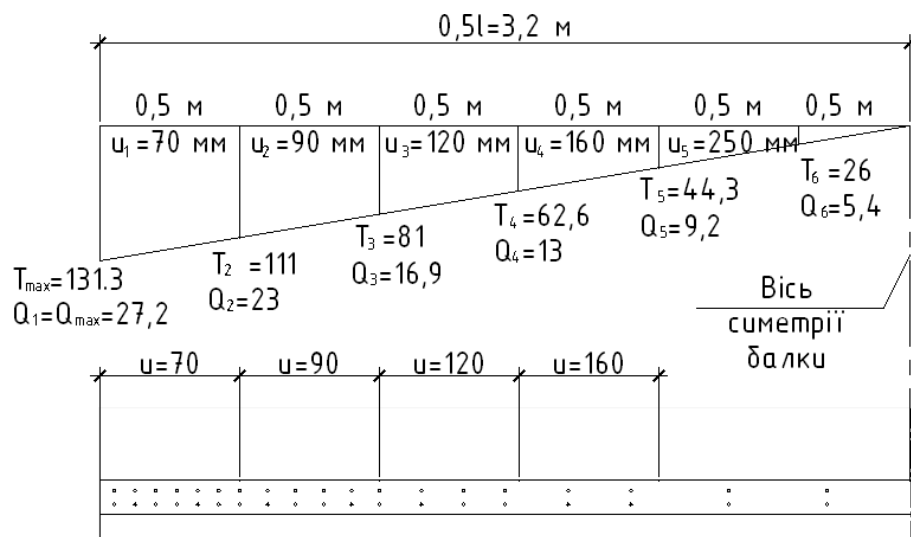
Поєднані епюри поперечних сил та зусиль зсуву та схема розташування нагелів в тілі балки.
